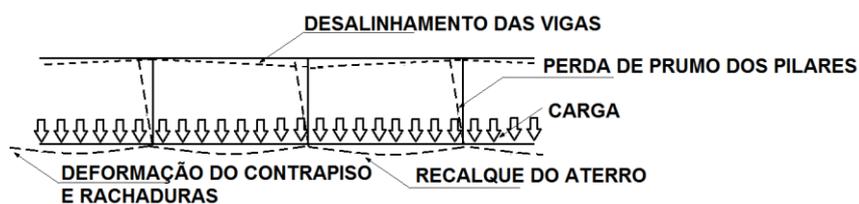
Croqui demonstrativo da movimentação da estrutura.
